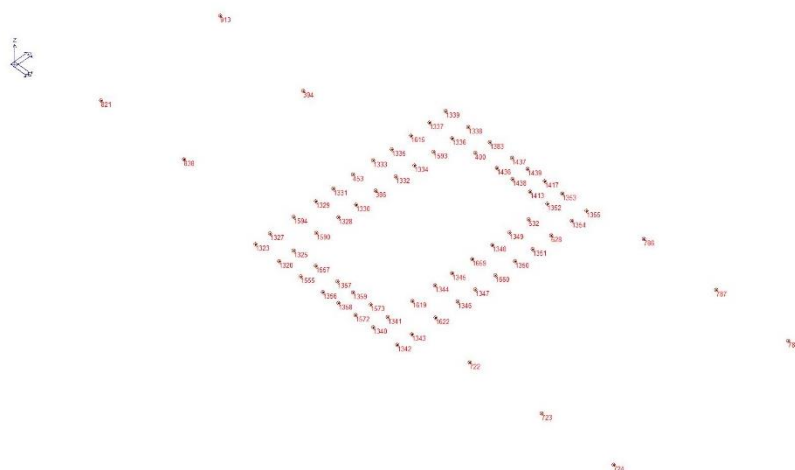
Numerazione degli elementi di fondazione pali e plinti
